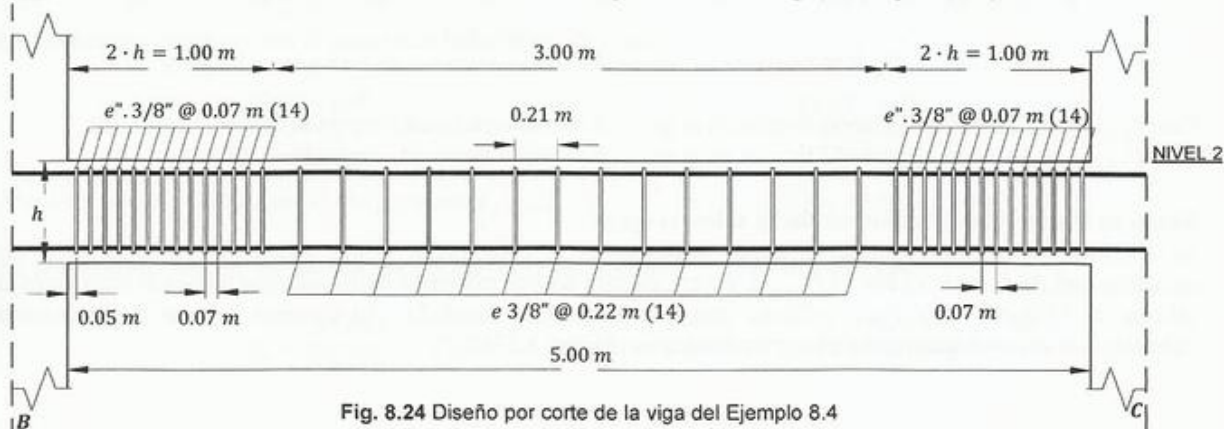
Diseño por corte de la viga del Ejemplo 8.4
